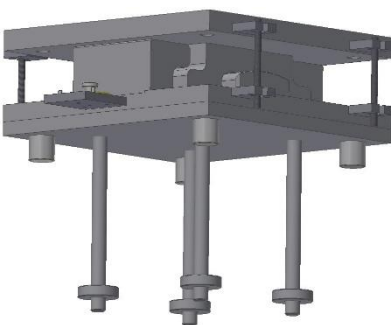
Lagertyp LKZe,L, mit Rückverankerung gegen klaffen der Fuge und Abhebesicherung für Zuglasten, oben Stahl & unten Betonanschluss.
